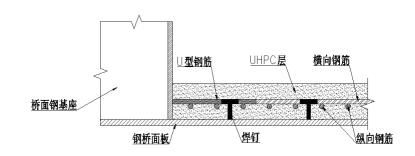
UHPC 层与混凝土结构连接立面示意图
